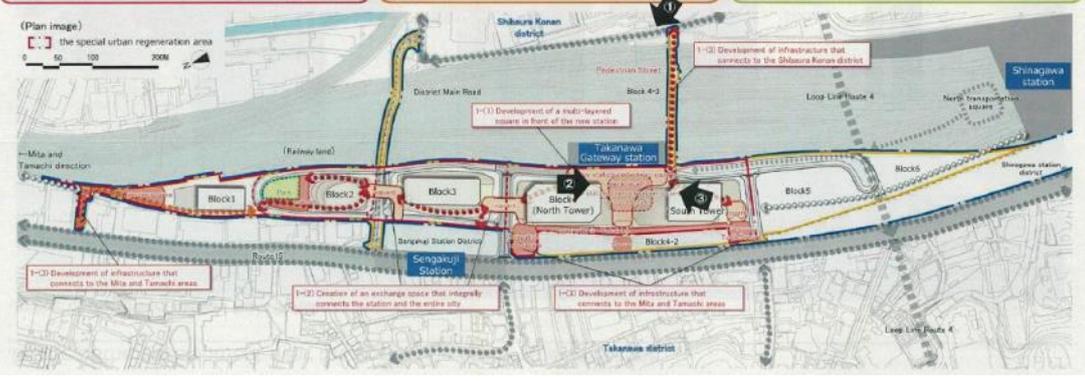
高輪 Gateway 新站與周邊開發平面示意圖【1】
